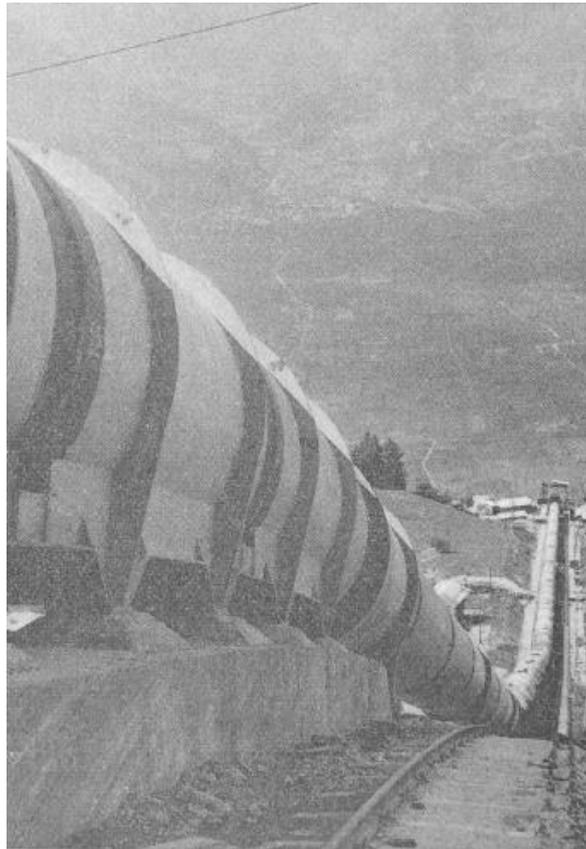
Conduite forcée avec des blocs d'ancrage en béton.
